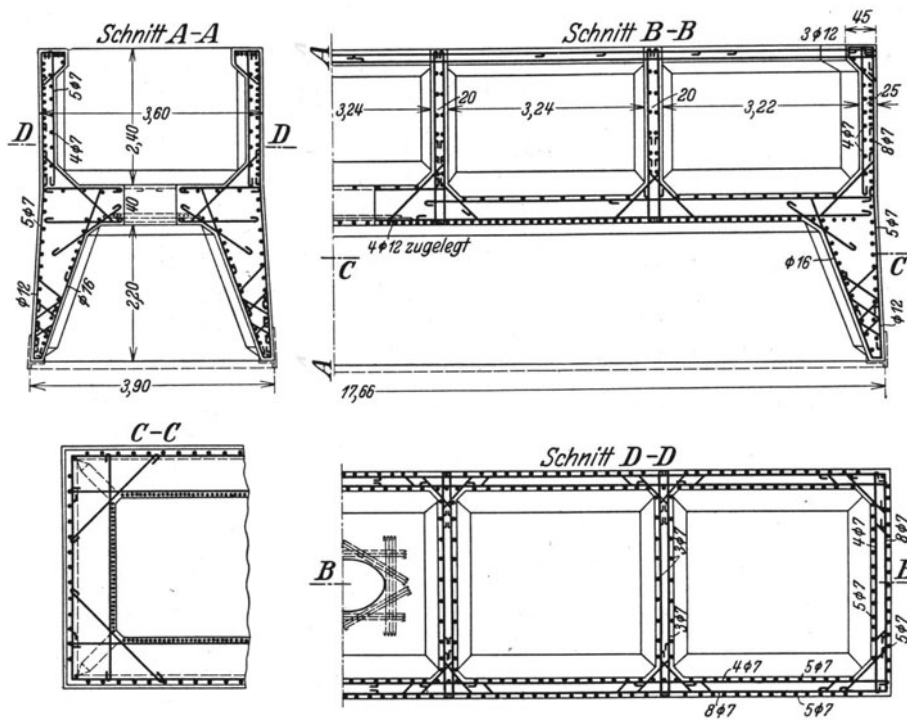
Eisenbetondruckkasten mit Rippendecke und vollen Konsolen der Pfeiler der Traunbrücke bei Ebelsberg, Oberösterreich. (Wayss & Freytag.)
